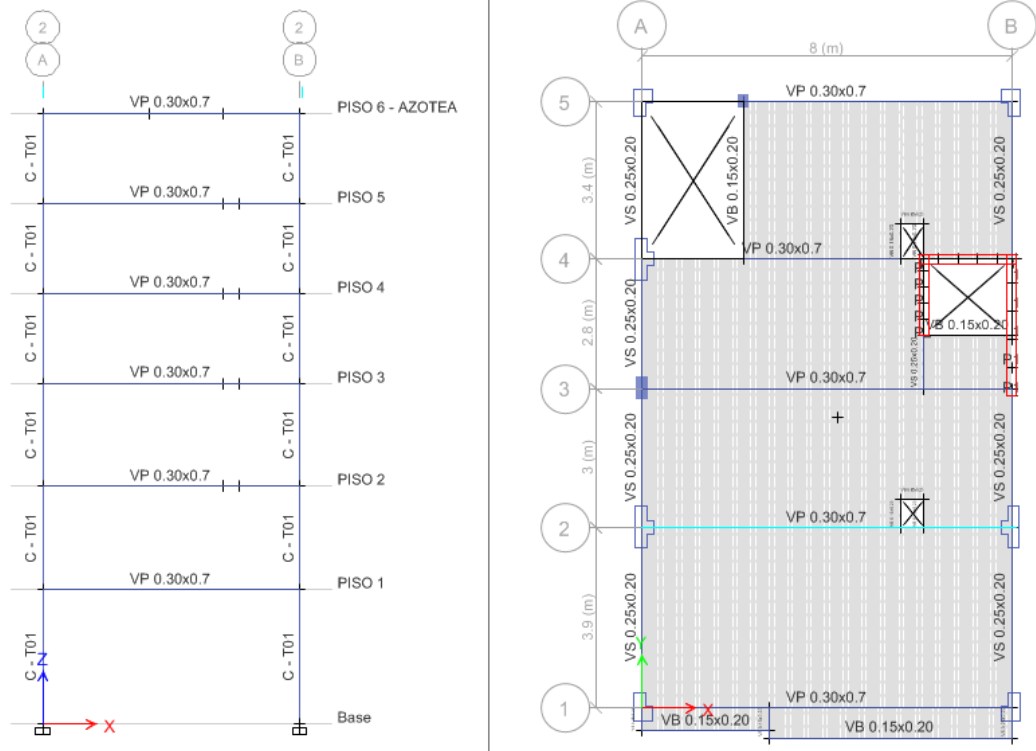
27 Vista en elevación y planta típica del pórtico principal 2 - CASO N°08
